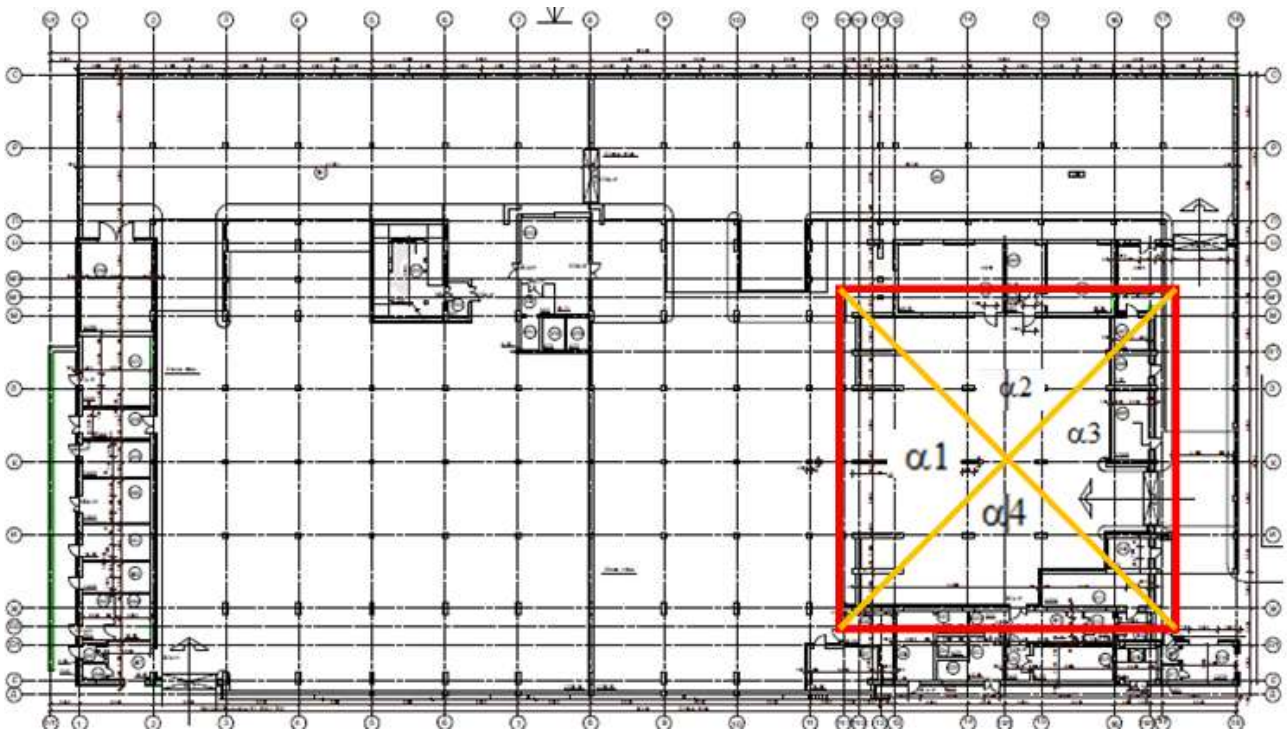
План захисного приміщення розташованого на першому поверсі
